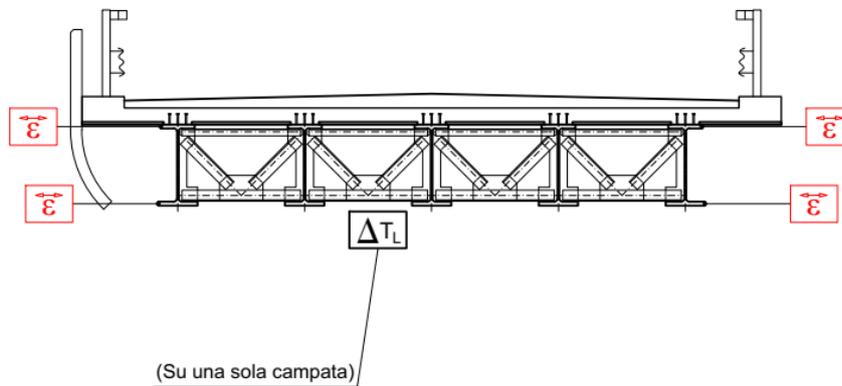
Ubicazione sensori su impalcato sezione a 5 travi (sezione trasversale viadotto Collestrada)
